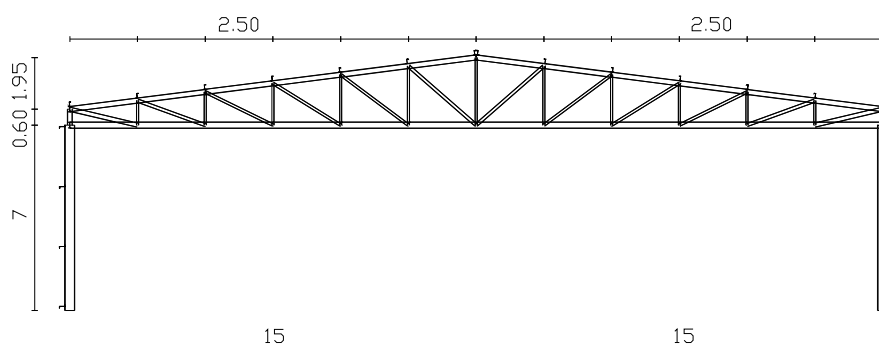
Pórtico com pilar de alma cheia, viga em treliça, vão de 30.00m
